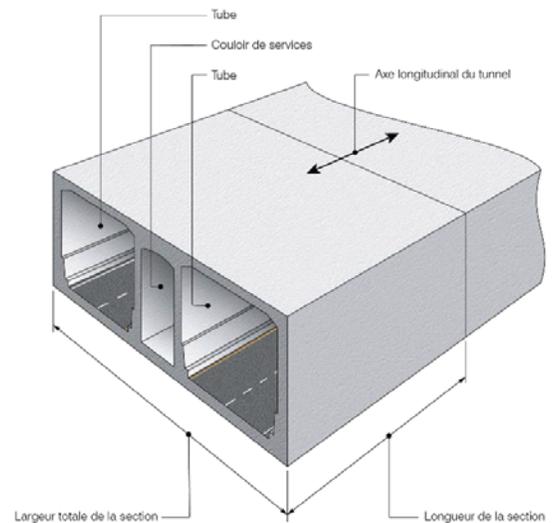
Largeur totale d'une section de tunnel constituée de plusieurs tubes
